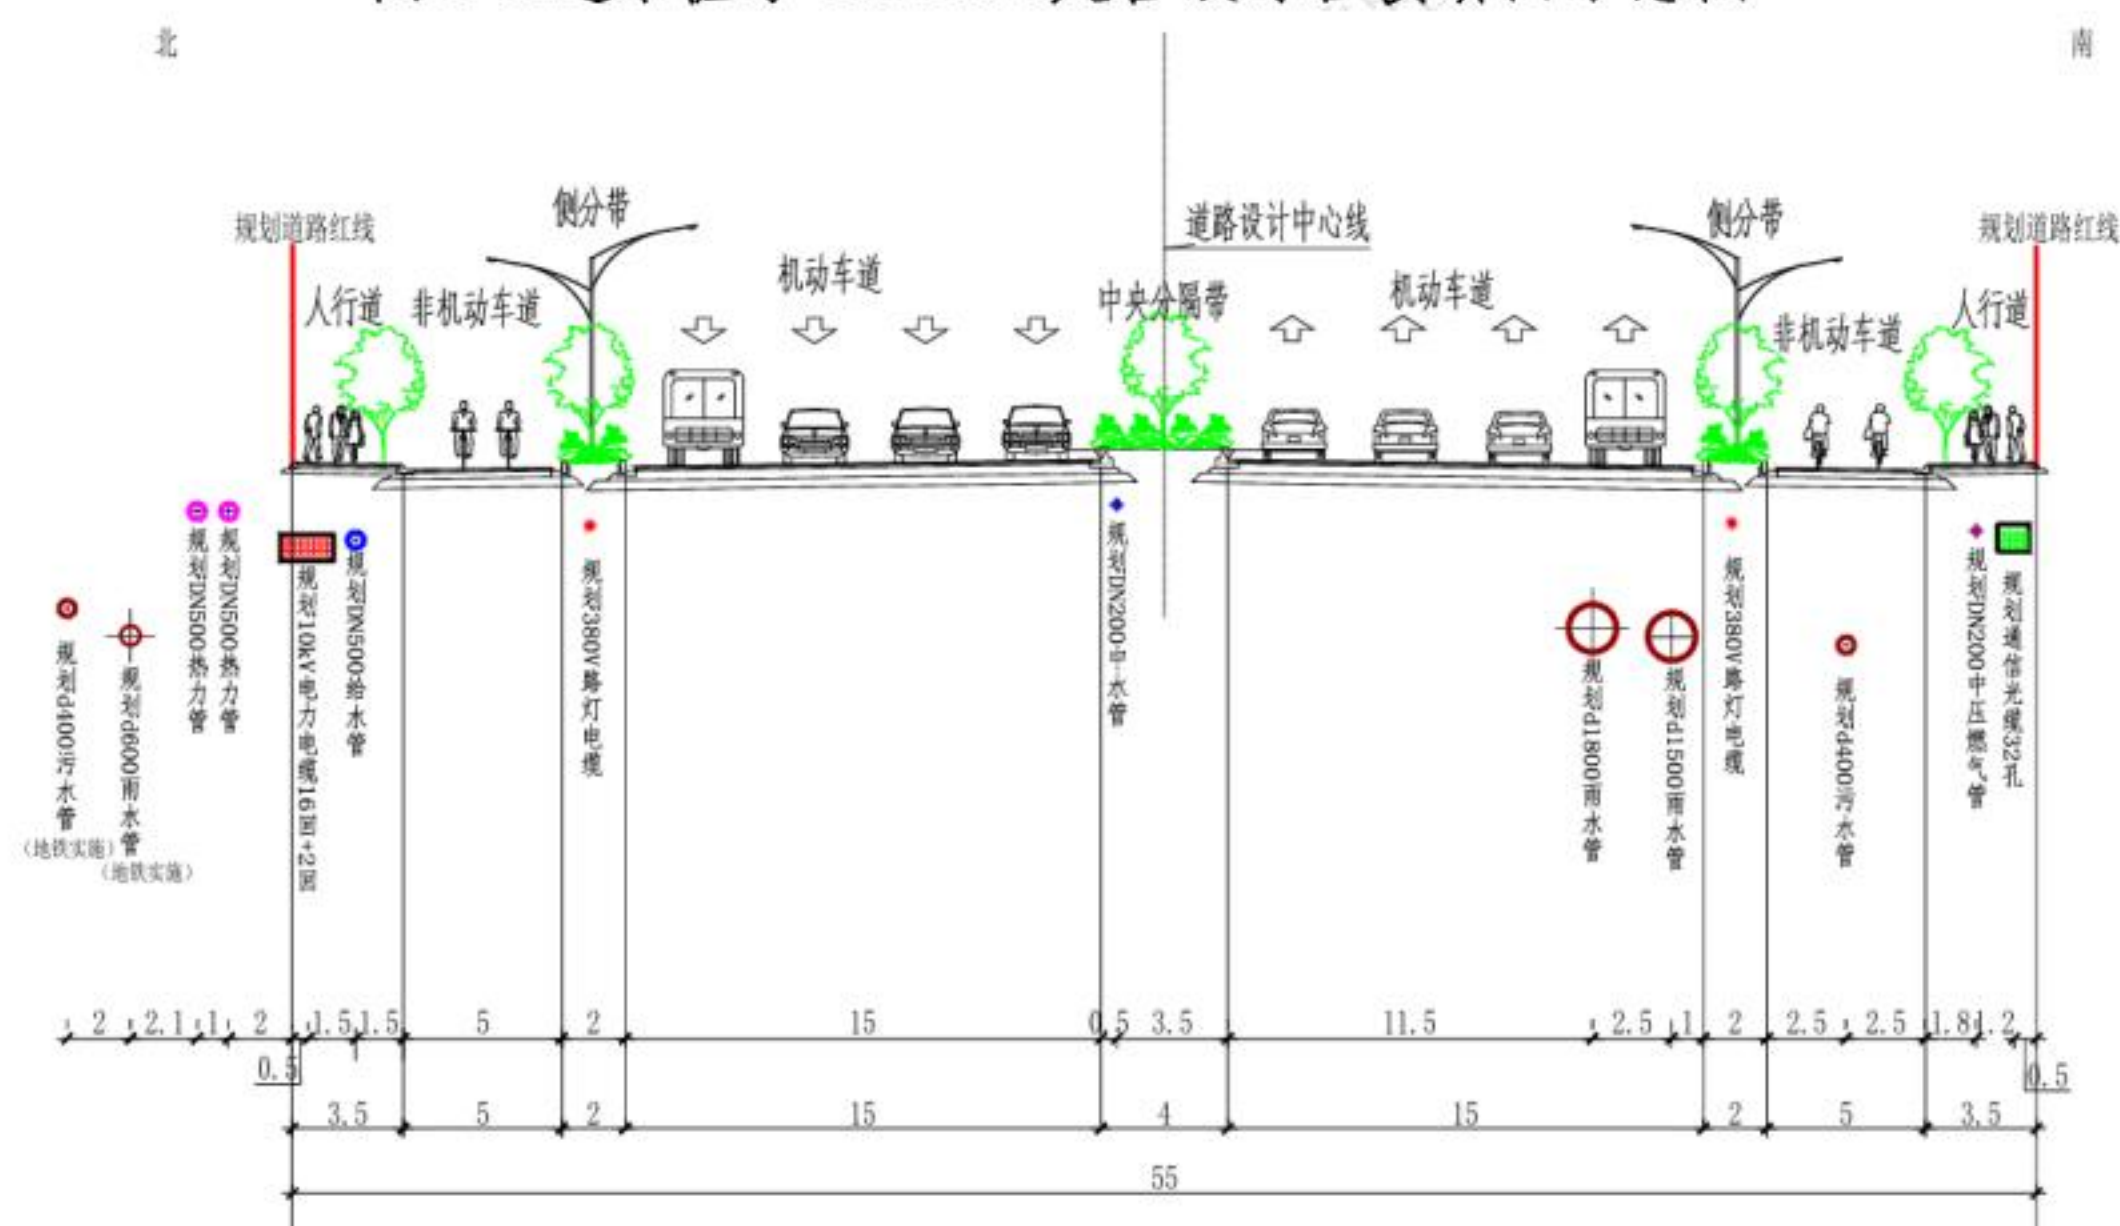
道路桩号 K0+700 处管线综合横断面示意图
